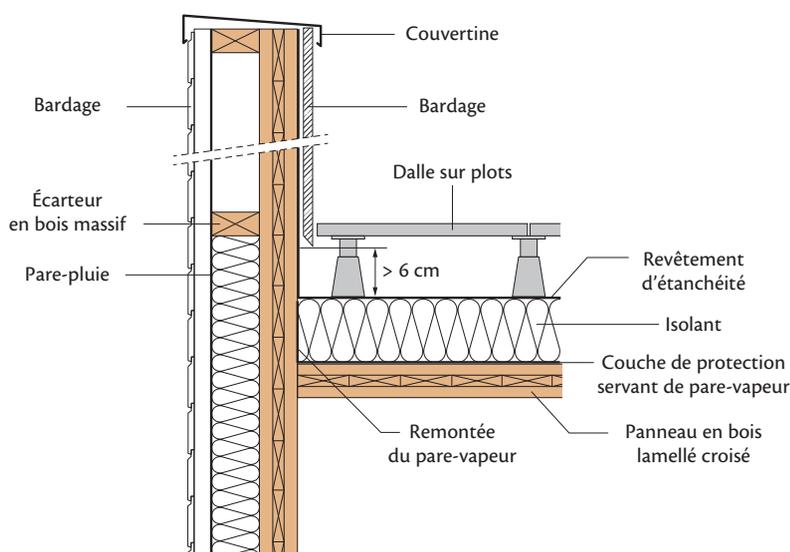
Principe de toitures-terrasses accessibles aux piétons avec protection par dalles sur plots. Isolation support d'étanchéité. Coupe perpendiculaire à la pente
